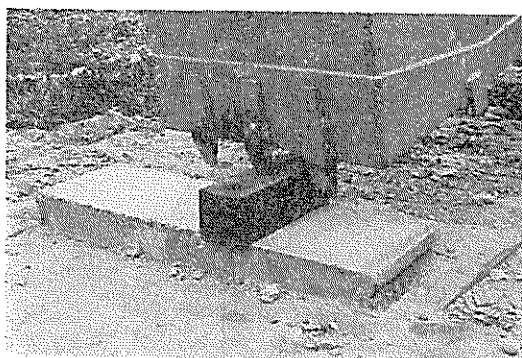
コンクリート台盤上に置いた鉄塊上への落下試験
